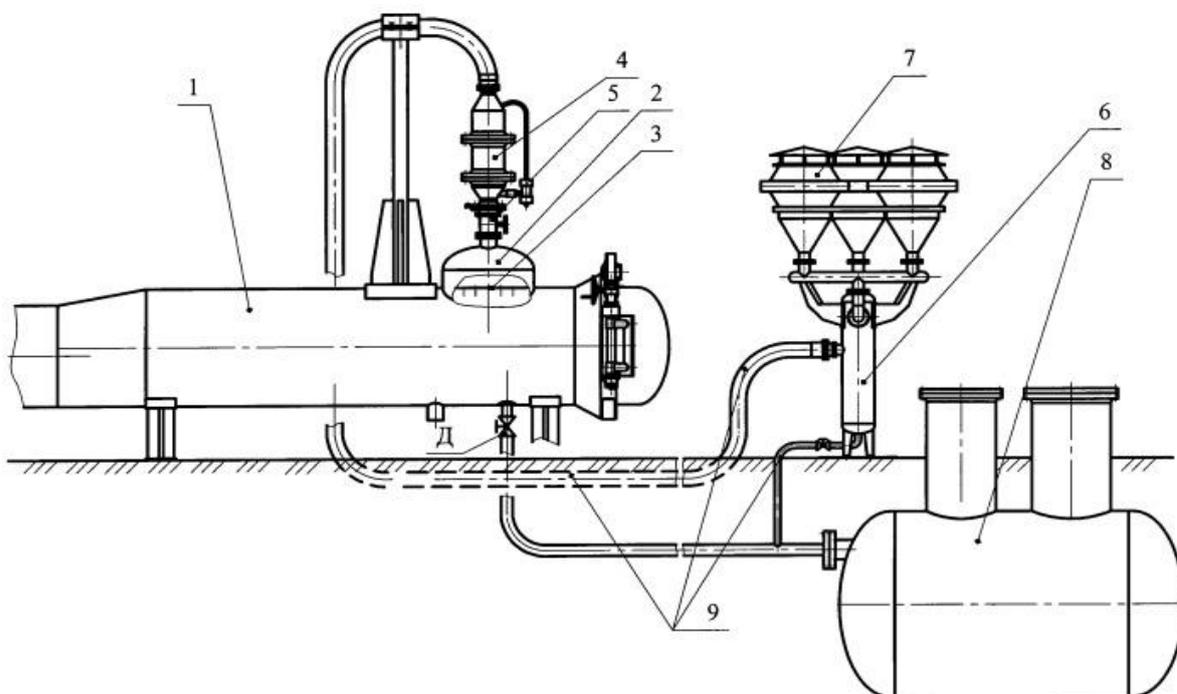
Схема выпуска газовой смеси из трубопровода
